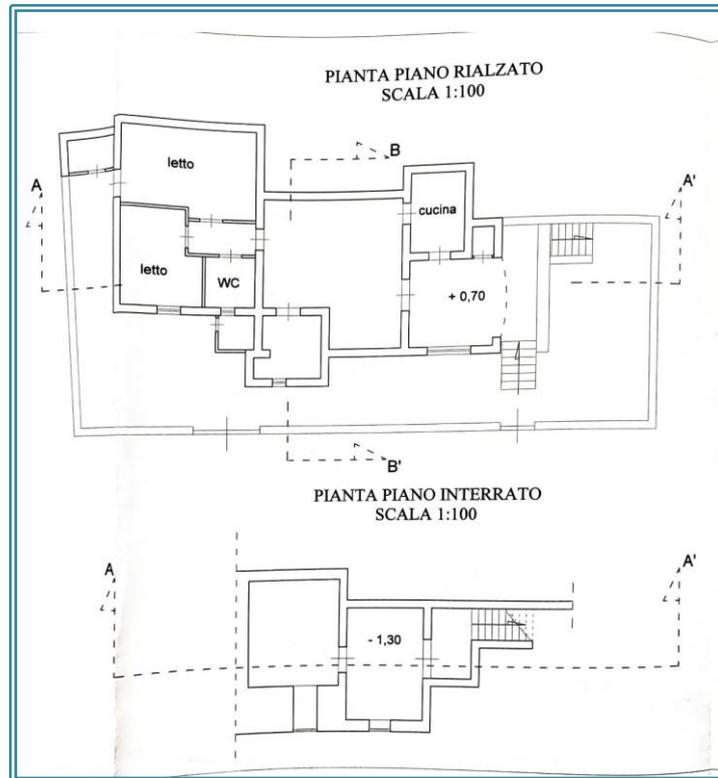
Pianta Piano Rialzato e Interrato – P.d.C. in sanatoria n. 08/17
